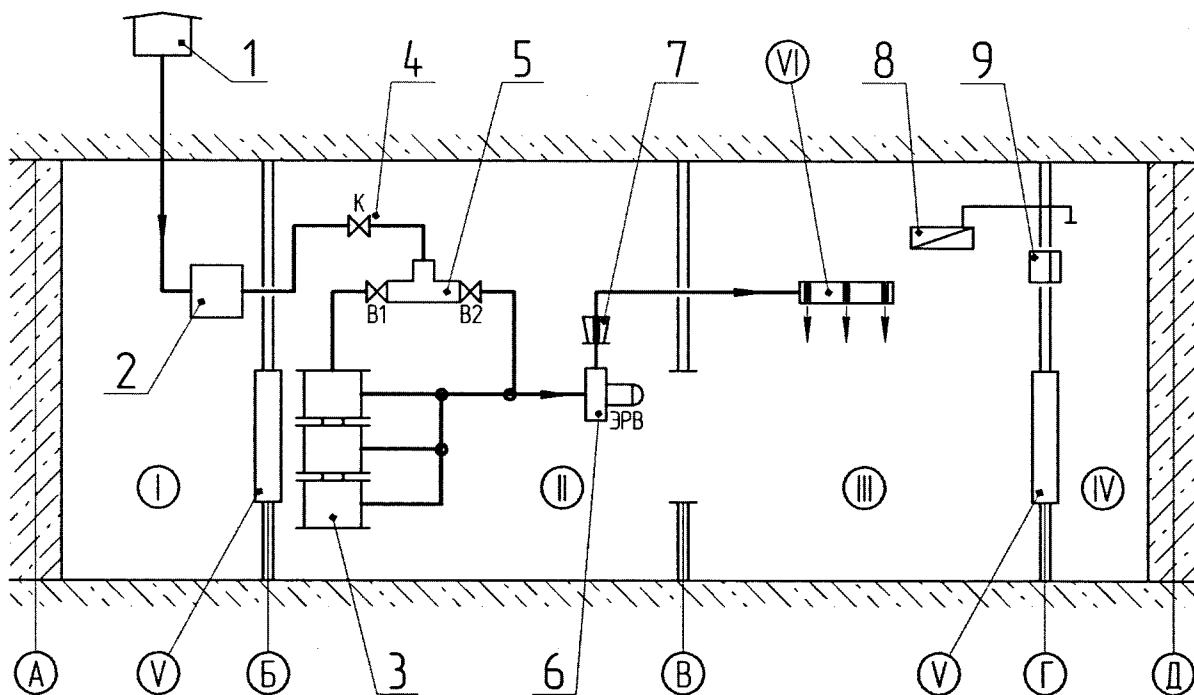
Схема размещения фильтровентиляционной установки в защитном сооружении (убежище).
